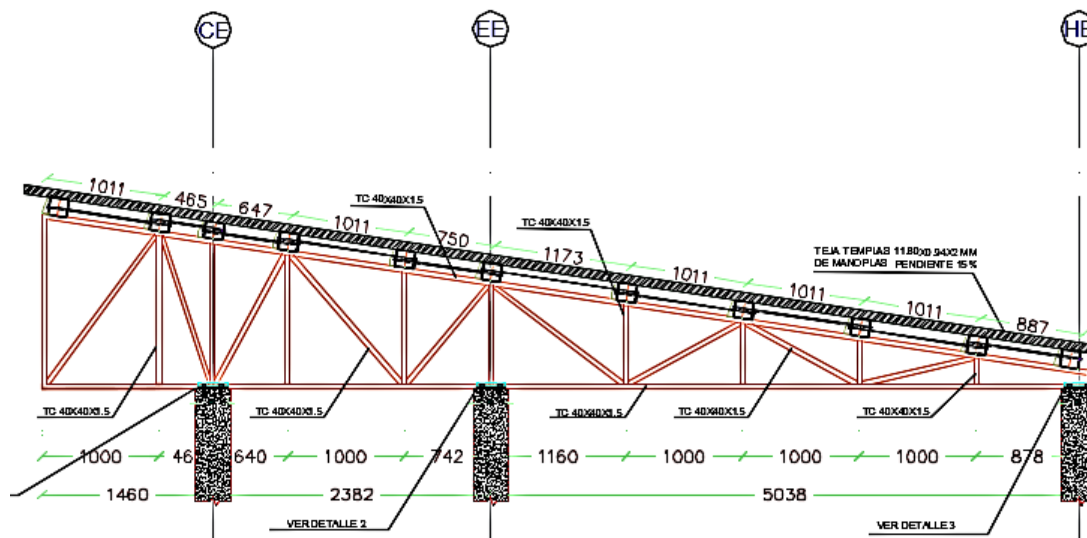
Cercha Tipo 1, Zona A. Fuente: Autor
